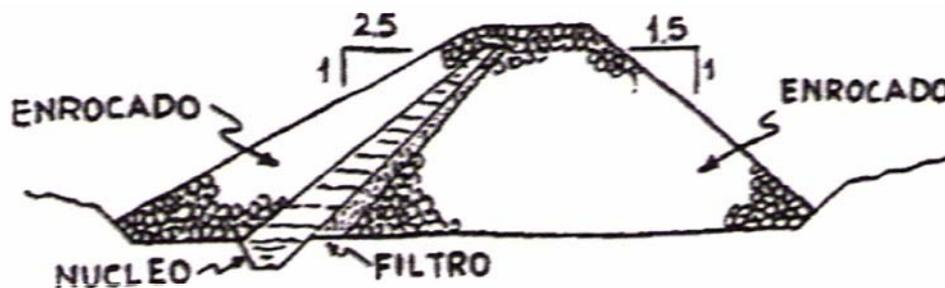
Presa heterogénea con núcleo inclinado [3]
